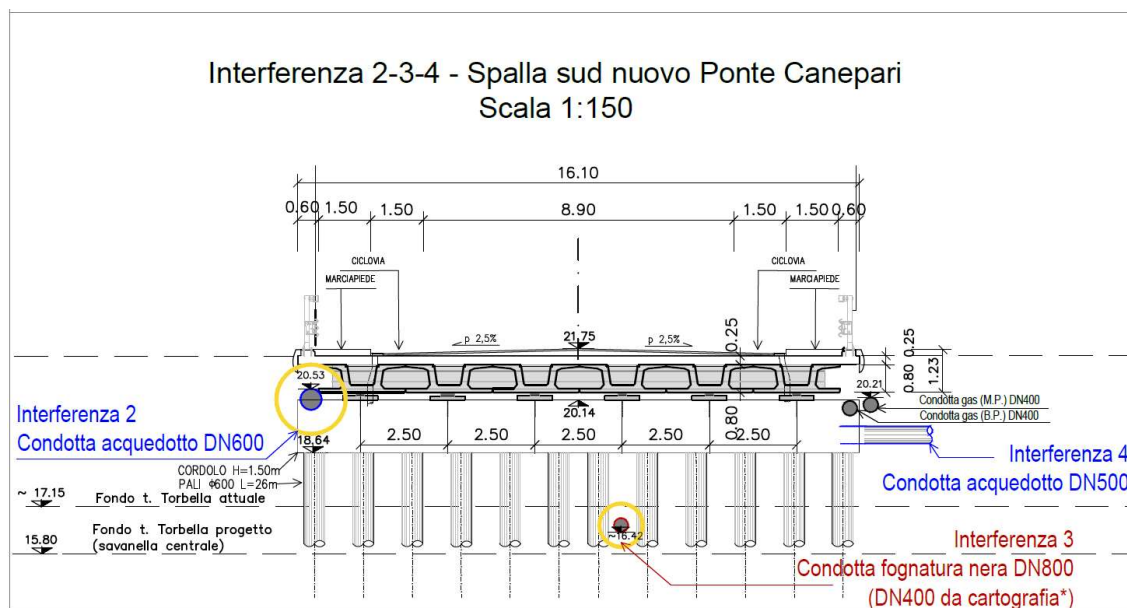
Sezione trasversale del nuovo ponte di via Canepari in corrispondenza della spalla sud
